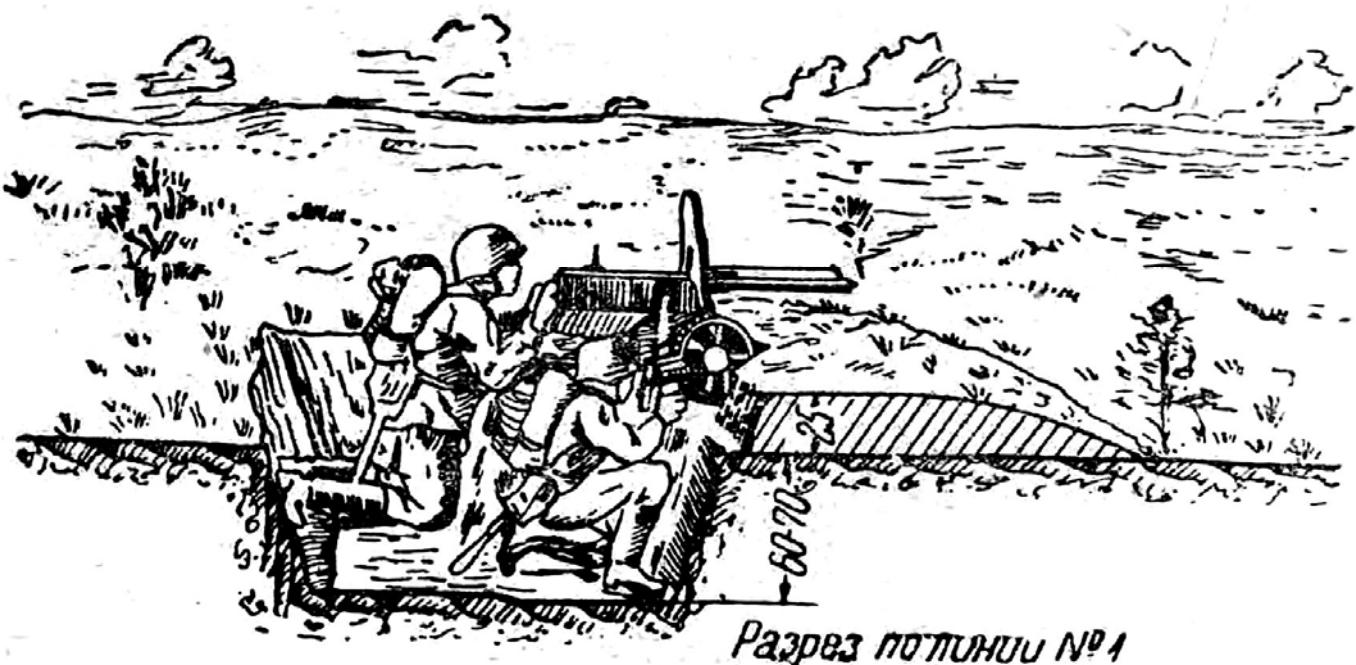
Ячейка для стрельбы лежа из станкового пулемета
